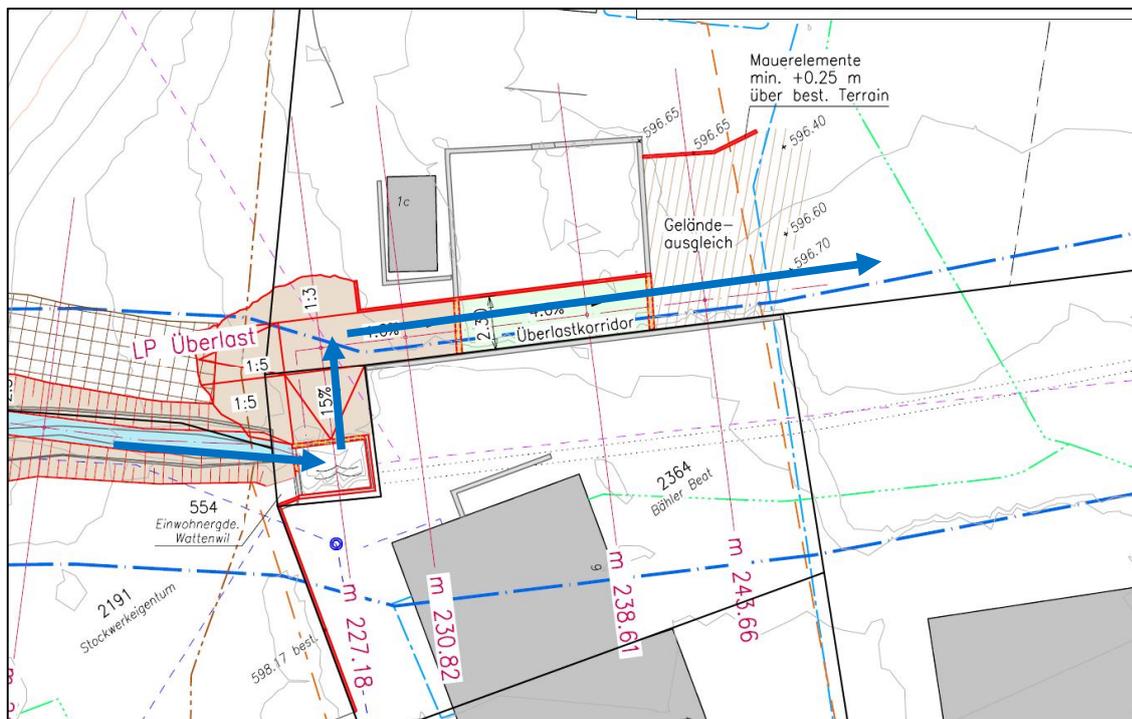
AUSSCHNITT SITUATIONSPLAN, BLAU = WASSERLENKUNG ÜBERLASTFALL
